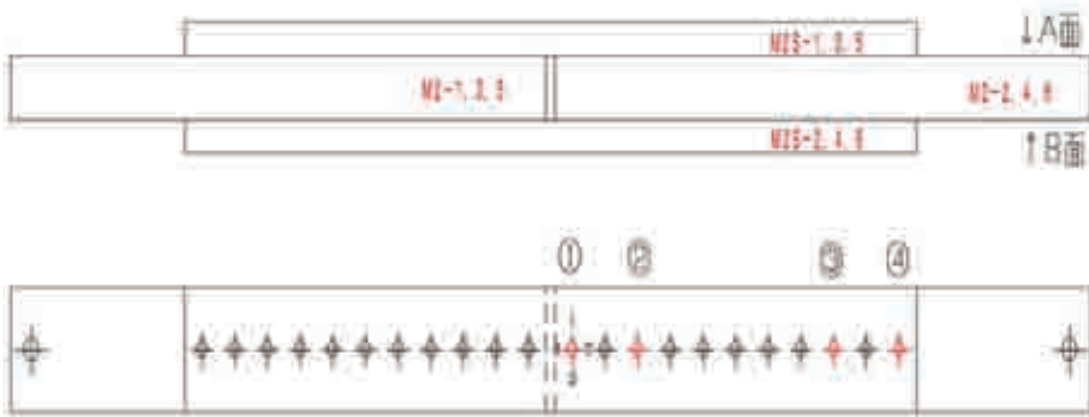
試験体 No.8 塗膜厚計測位置図
